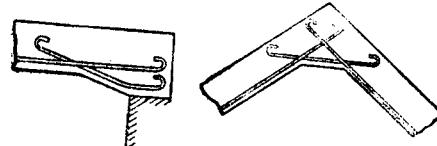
ハンチおよびラーメンの部材の接合部の内側に沿う鉄筋配置
